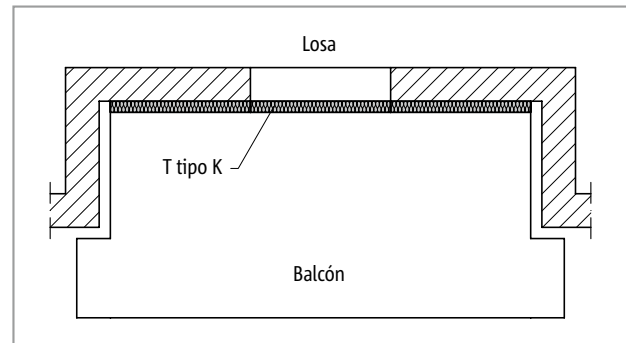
Schöck Isokorb® T tipo K: Balcón en fachada retranqueada
